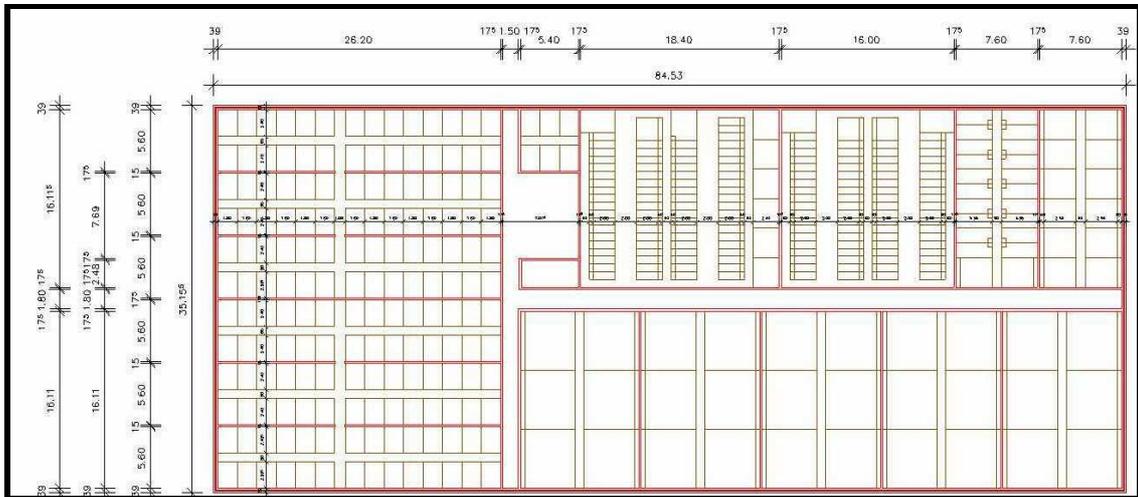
Stallgrundriss für einen Sauenstall mit rund 1500 Sauen, 4 Wochen Säugezeit und wöchentlichem Absetzen. Deckzentrum als Profideckstall im Rein-Raus-System. Wartestall mit Gruppenhaltung der Sauen in festen Großgruppen und Abruffütterung, Ausweichabteile für schwankende Absetzgruppengröße, Sozialtrakt, Nebenräume und Sauendusche zentral angeordnet.
